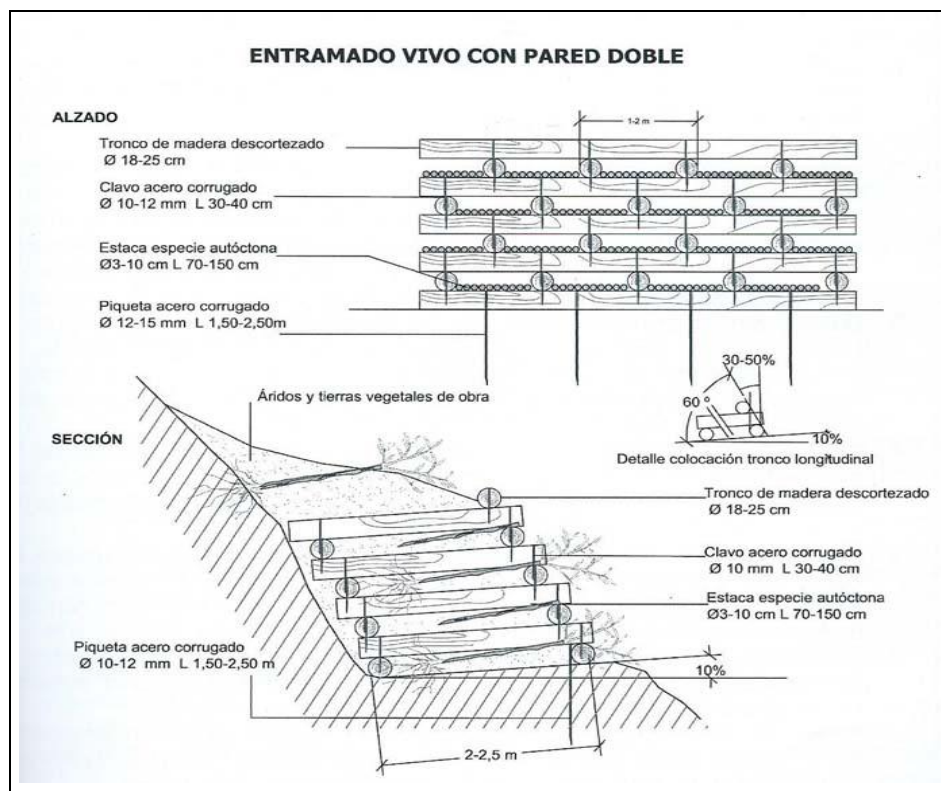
Detalle de alzado y sección de entramado vivo a doble pared. La distribución y anclaje de los troncos es igual al entramado de ribera. Fuente: NTJ 12S Parte 4, 2015.
